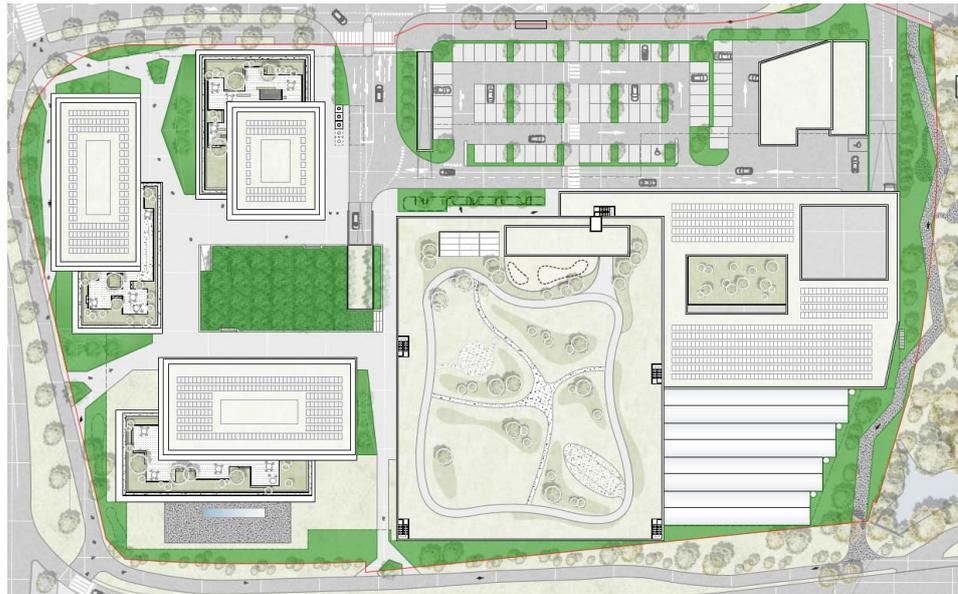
Grünflächen mit mind. 1.0 m Überdeckung grün markiert (iten landschaftsarchitekten gmbh, 2023)
